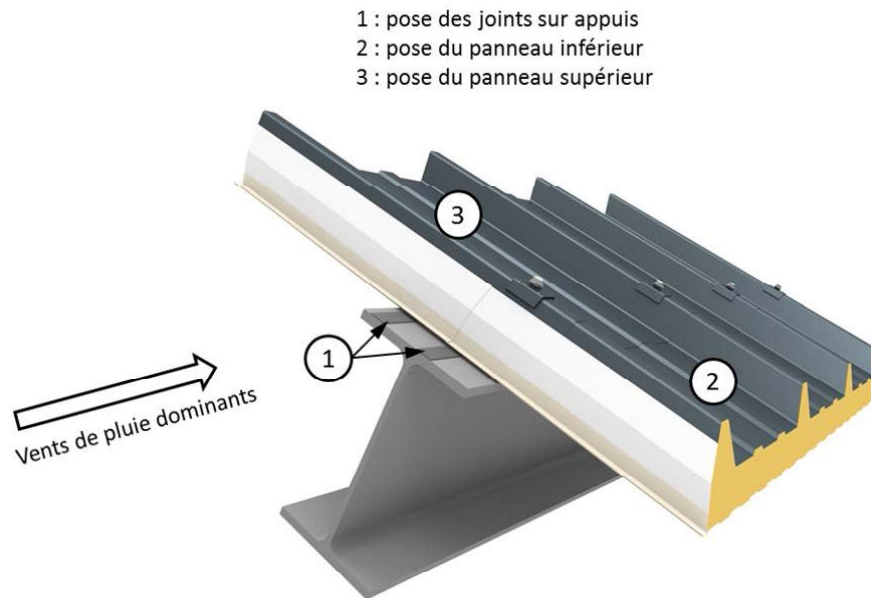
Détail sur appui – Joints sur appuis au droit d'un recouvrement transversal de panneaux sans complément d'étanchéité (C.E.) – locaux à faible ou moyenne hygrométrie (cf. §7.5)
